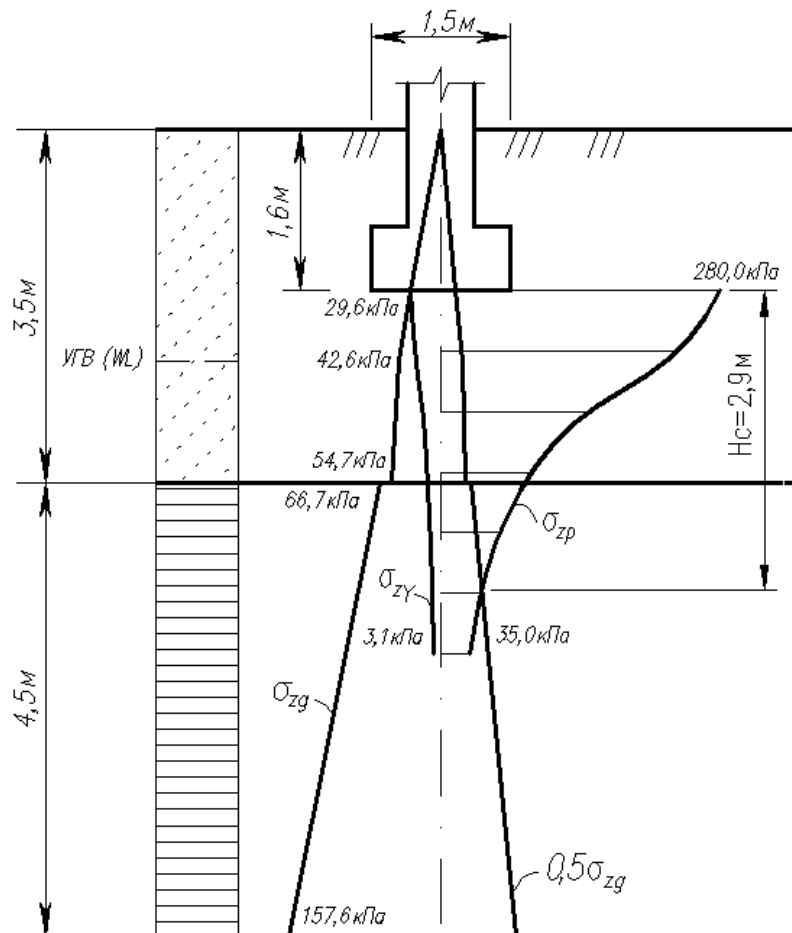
Схема к расчету осадки методом послойного суммирования
